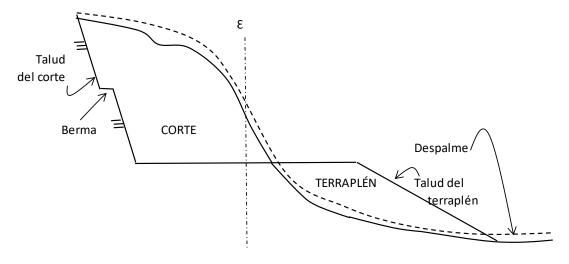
Sección transversal típica en balcón o mixta con corte y terraplén.
